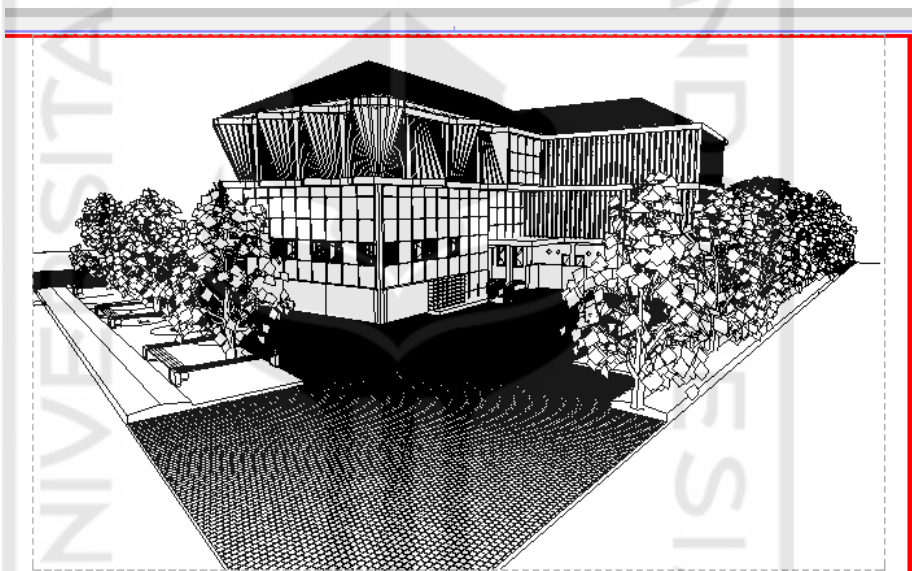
Rancangan Detail Arsitektural Khusus Bangunan 4
